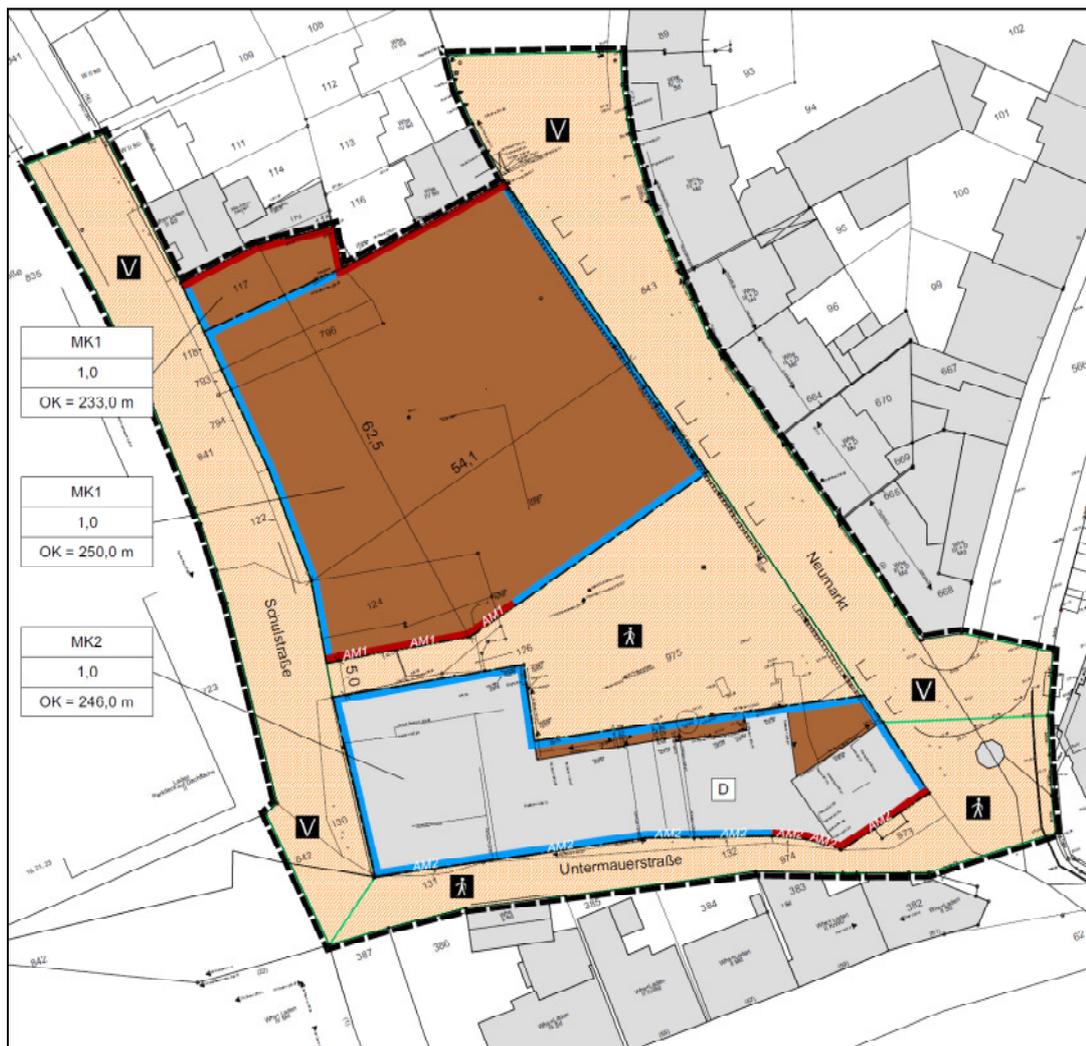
Plandarstellung des Bebauungsplans Nr. 103 im Entwurfstand vom Dezember 2019 [1]
